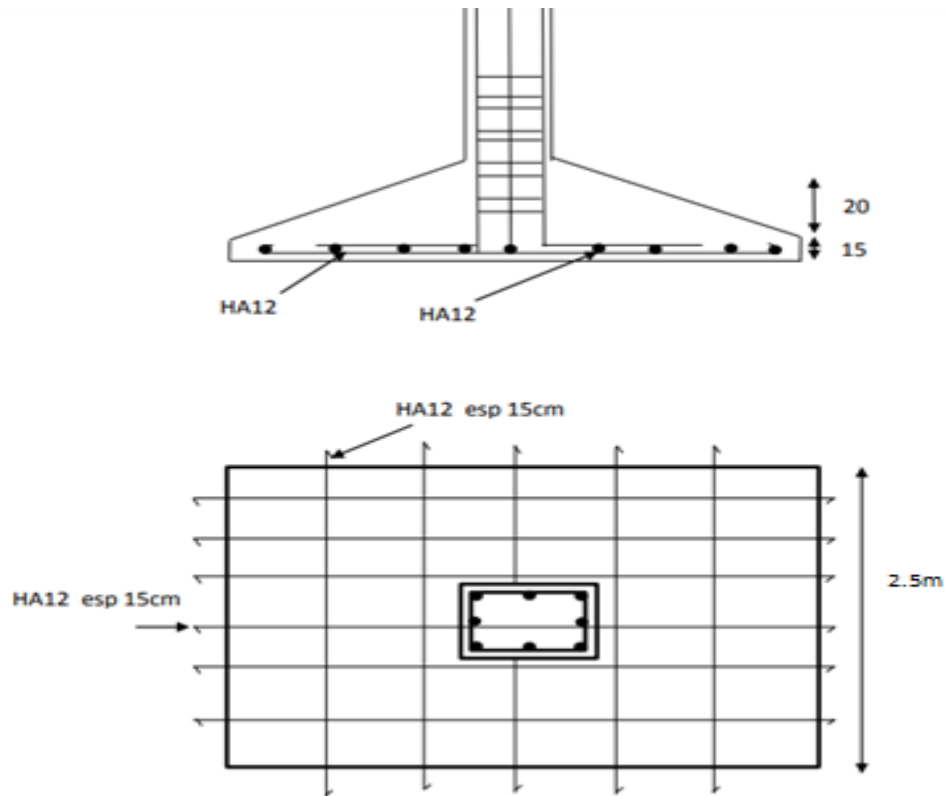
Schéma de ferrailage d'une semelle isolé
